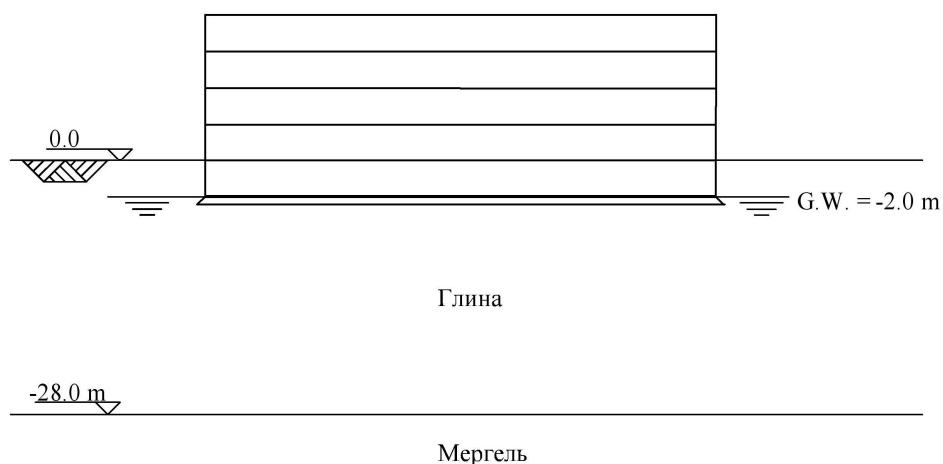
Вид сбоку здания на сплошном фундаменте
